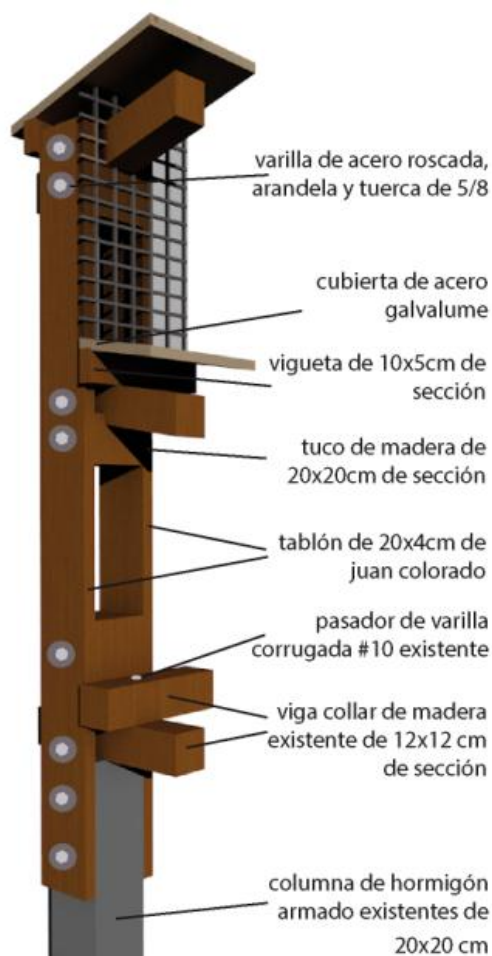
Proyección axonométrica de la estructura a construir para la propuesta de intervención
